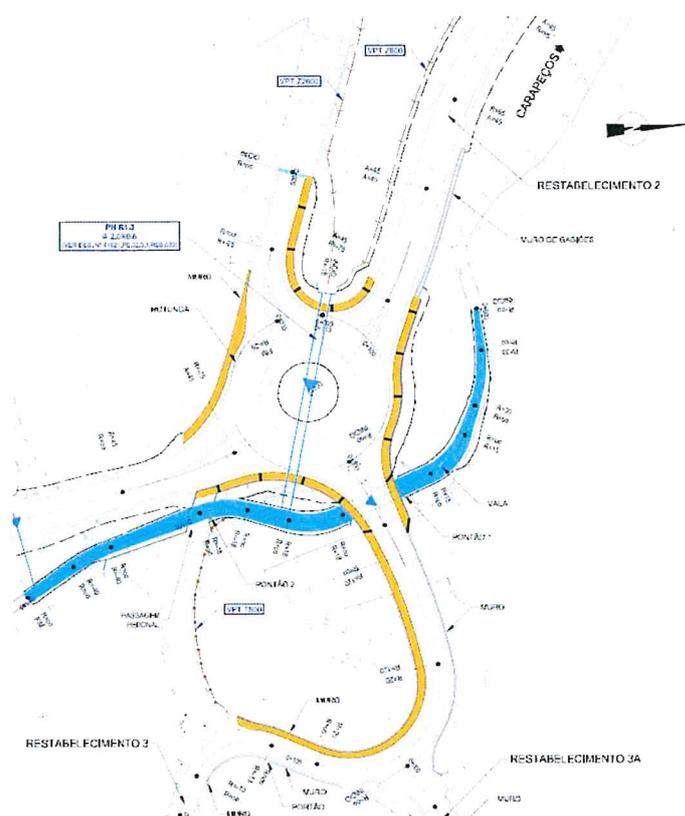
Drenagem – Planta, com identificação da PH R1.3 Rotunda, vala do Ribeiro do Pedrinho, Pontão 1 e Pontão 2.
